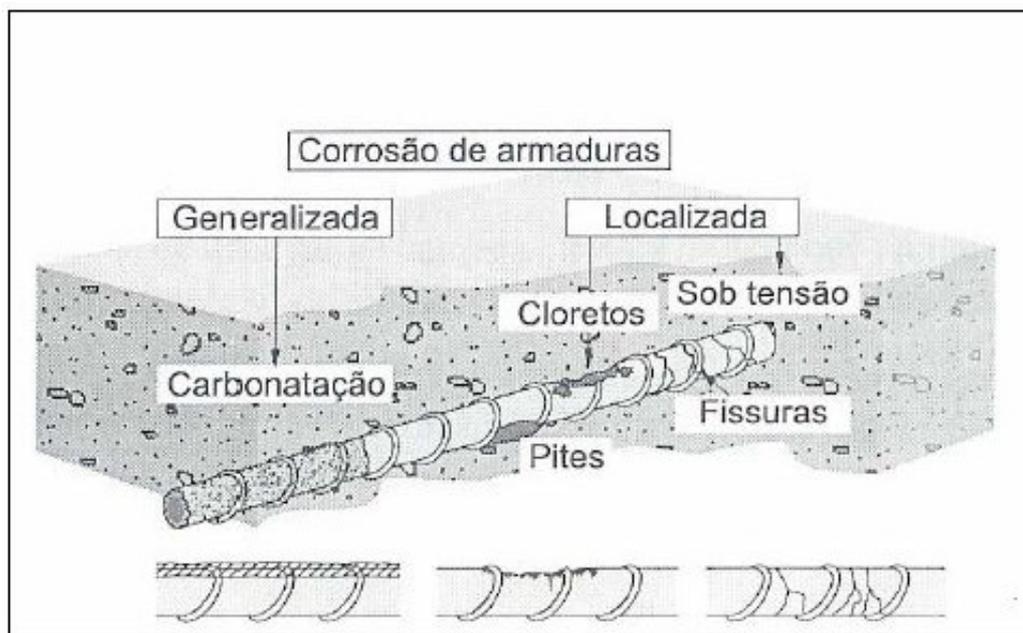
Tipos de corrosão da armadura: generalizada, pite e fissuras
